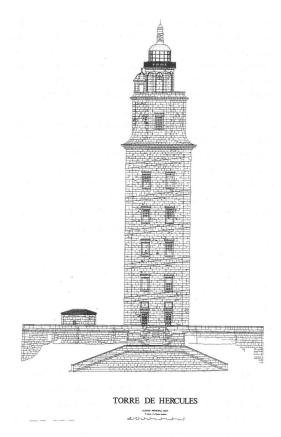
Alzado principal este. Levantamiento fotogramétrico del estado previo
